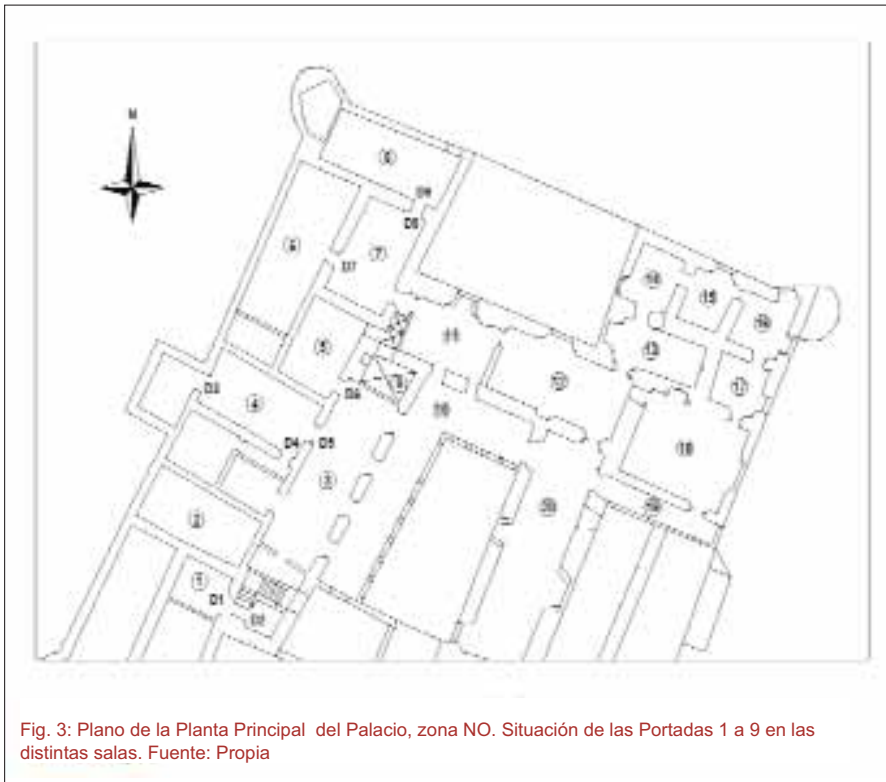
Plano de la Planta Principal del Palacio, zona NO. Situación de las Portadas 1 a 9 en las distintas salas. Fuente: Propia
